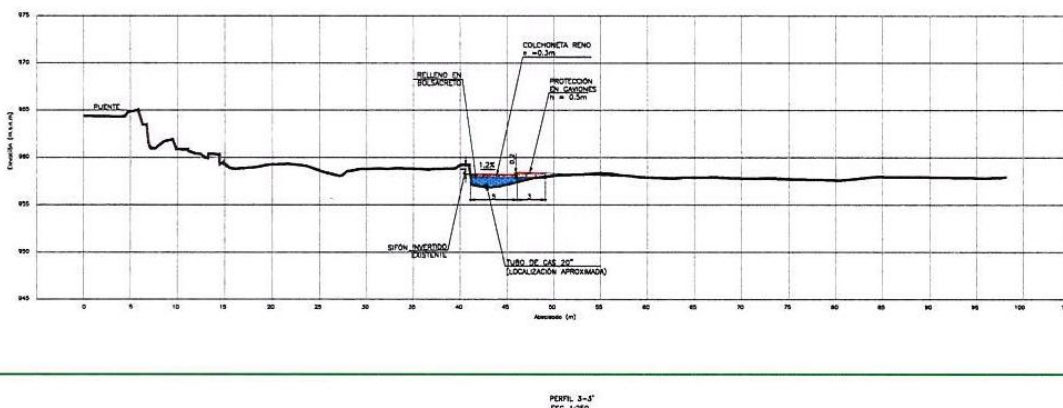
Detalle de las obras de protección, vista en corte longitudinal.
